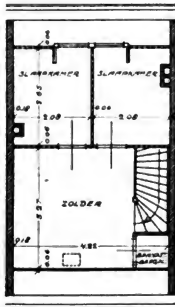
Grundriß zu Abb. 161, Obergeschoss.
